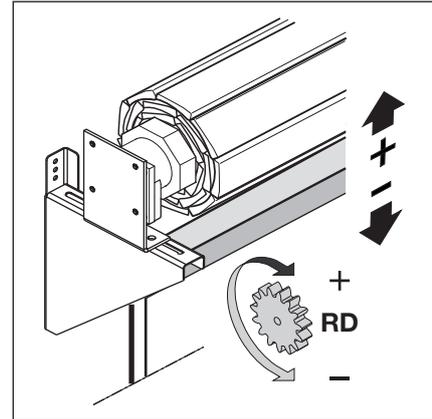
Rändelschraube für die Endlage *Tor-Auf
